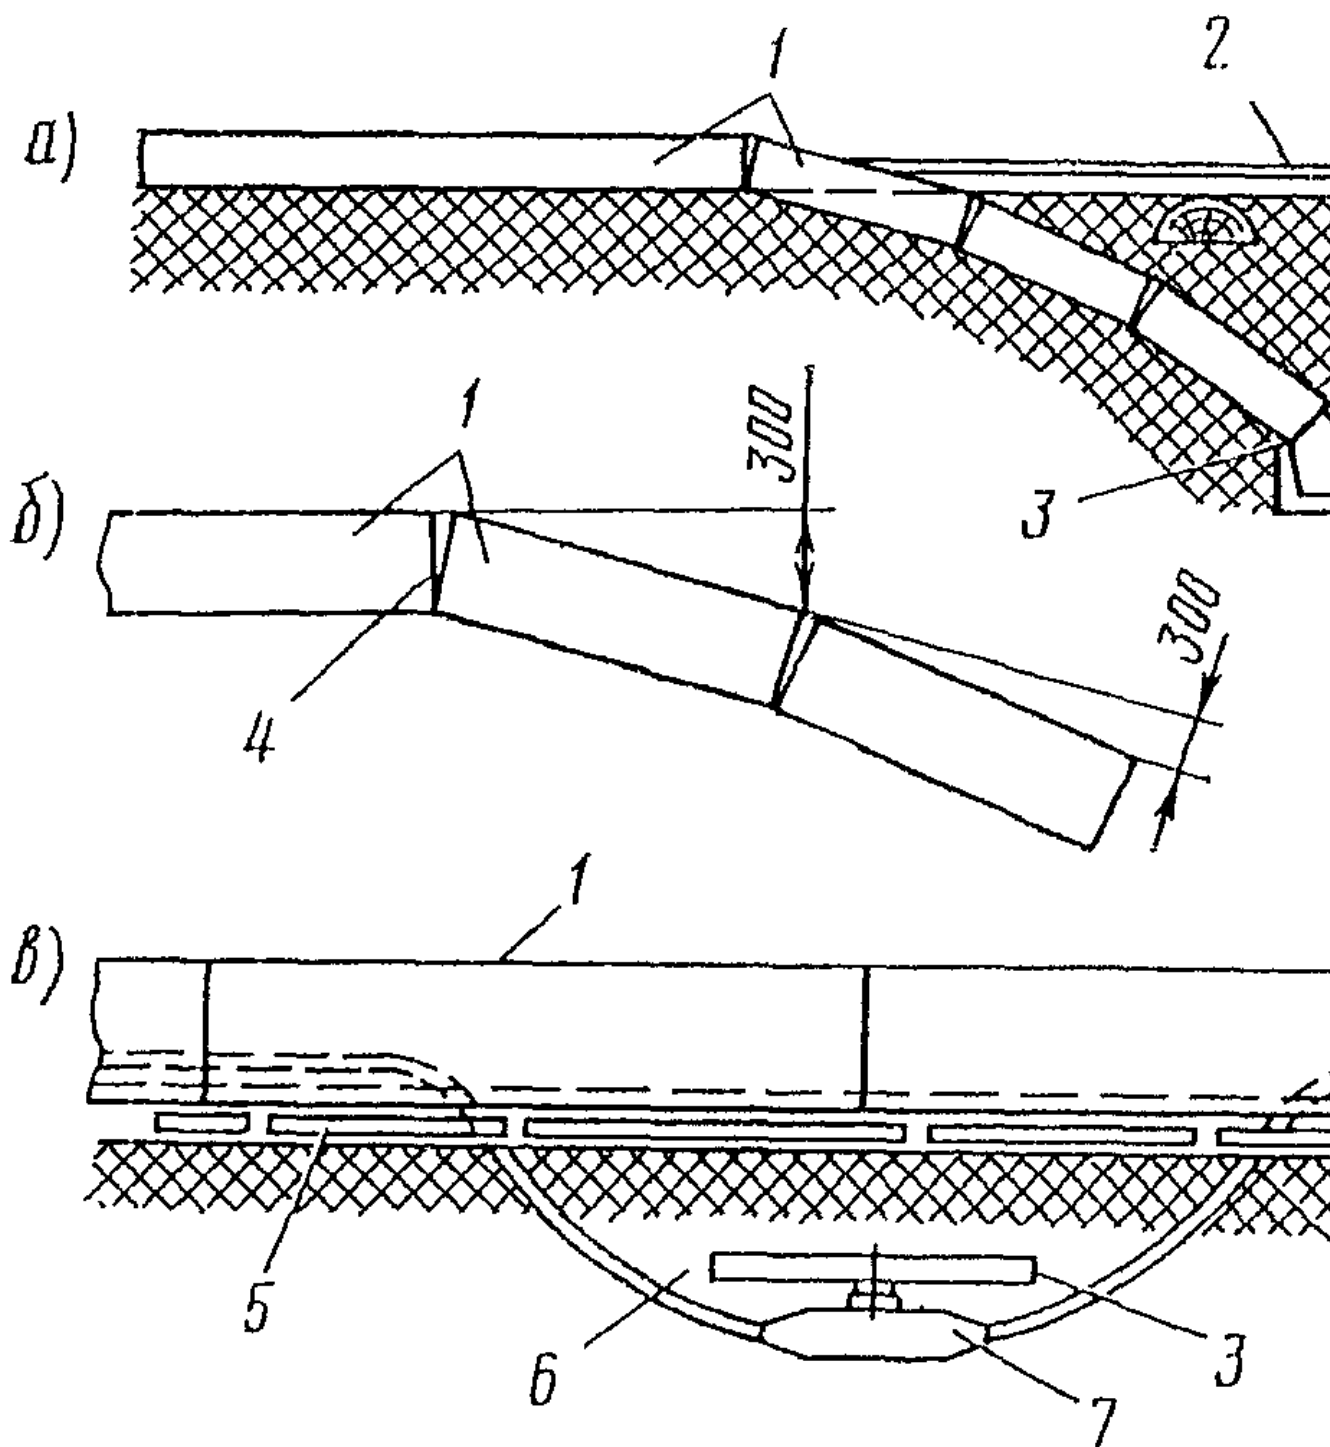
Установка железобетонных желобов: а - под путями; б - при заглублении на прямом участке; в - в местах ответвления кабелей; 1 - секция желоба; 2 - рельс; 3 - кирпич или плита; 4 - цементная заделка; 5 - прокладки; 6 - песок; 7 - соединительная муфта; 8 - кабель
